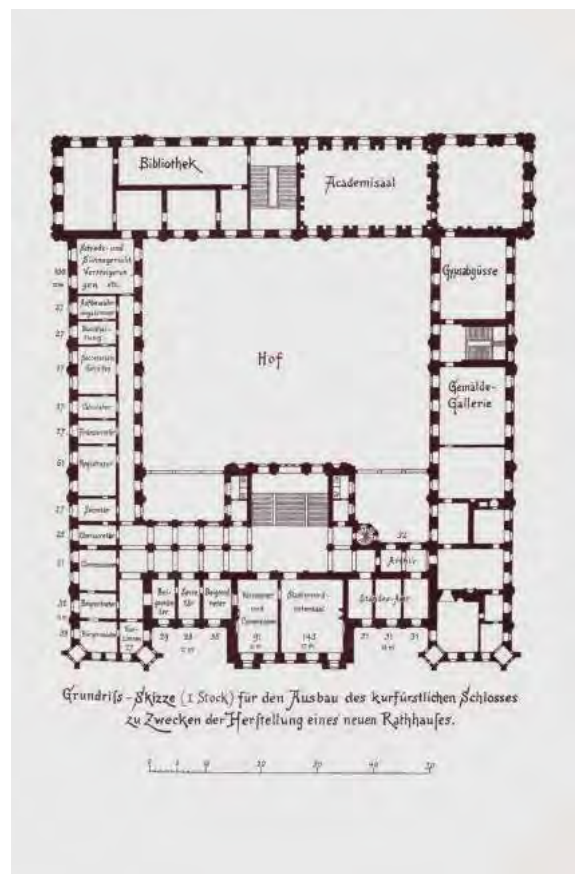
Nicola Racke: Projekt zum Ausbau des Schlosses als Rathaus, 1889, schematische Grundriss-skizze des 1. Obergeschosses.
